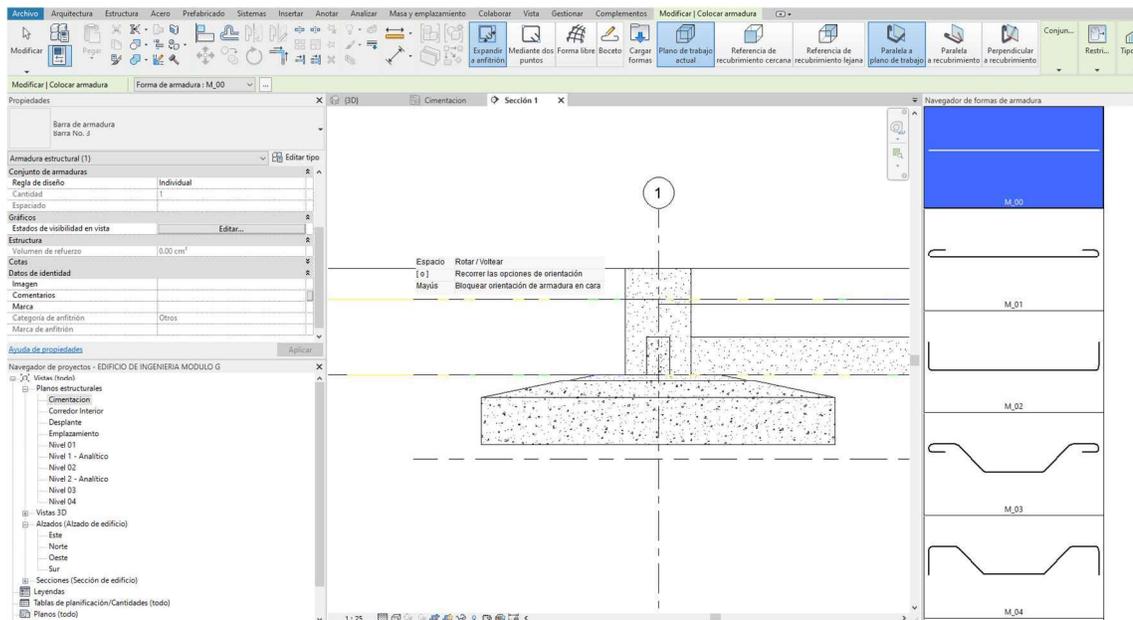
Opción de ir a la vista de sección para asignar refuerzo a la zapata
